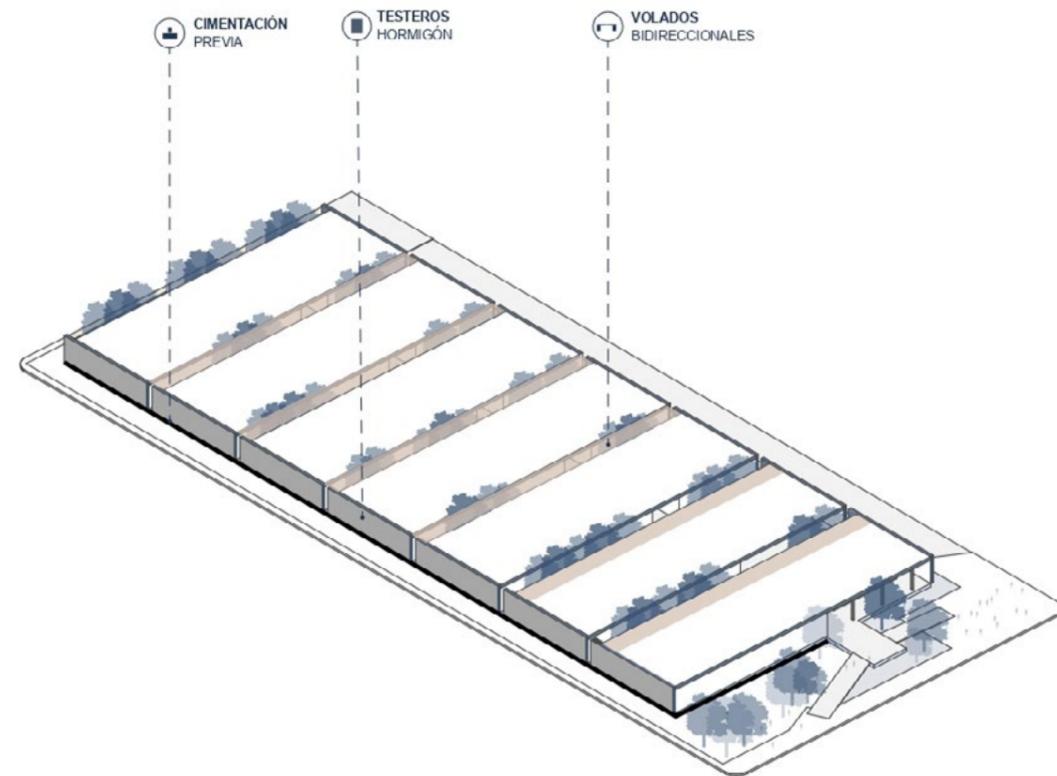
Estructura. Fuente: Elaboración propia, 2025.
